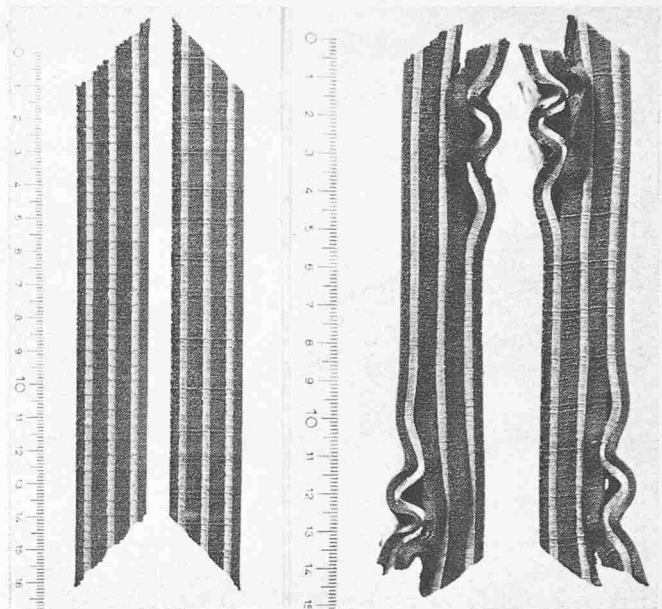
Bewehrte Elastomerelemente: Versuche an Lagerausschnitten Bruchversuch unter horizontaler Belastung:
